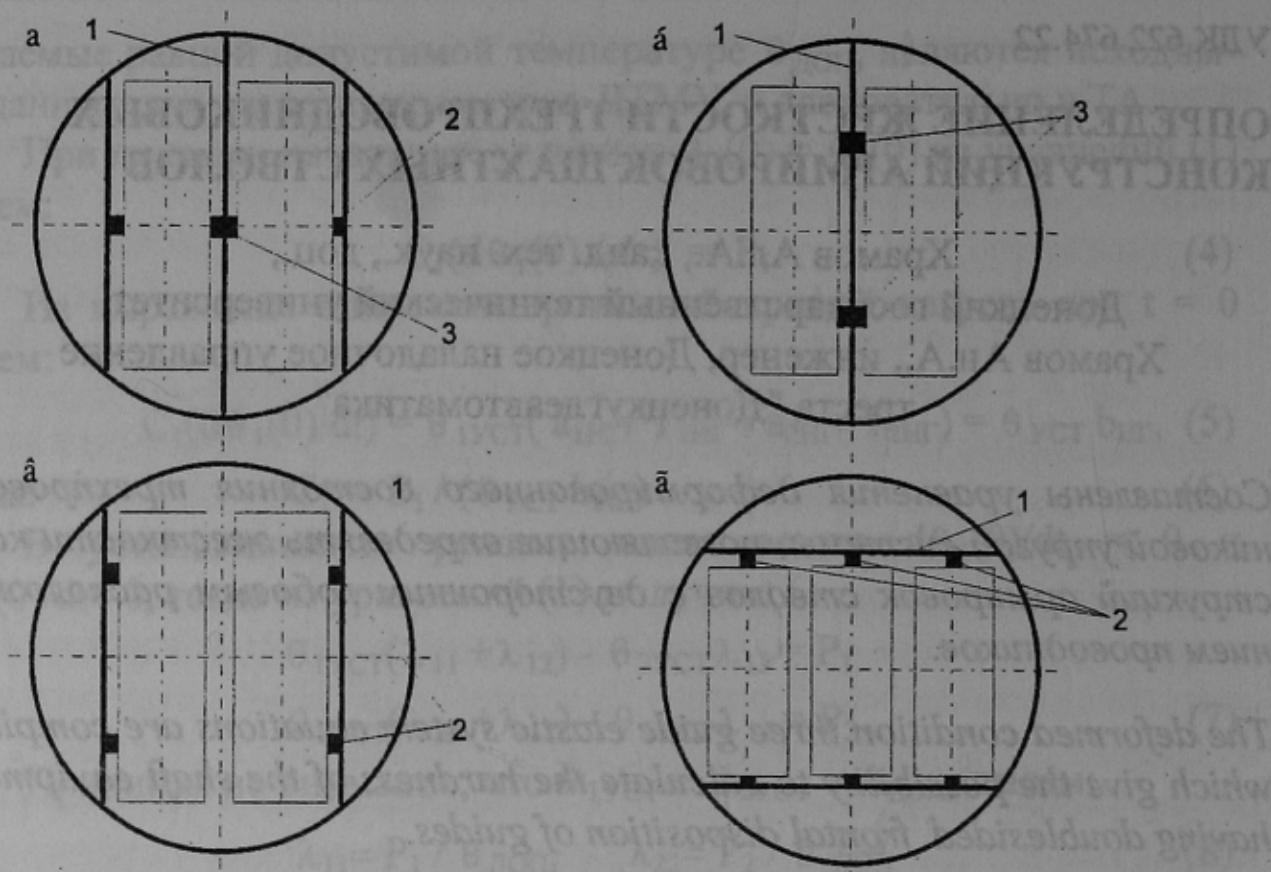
Конструкции жестких армировок шахтных стволов
